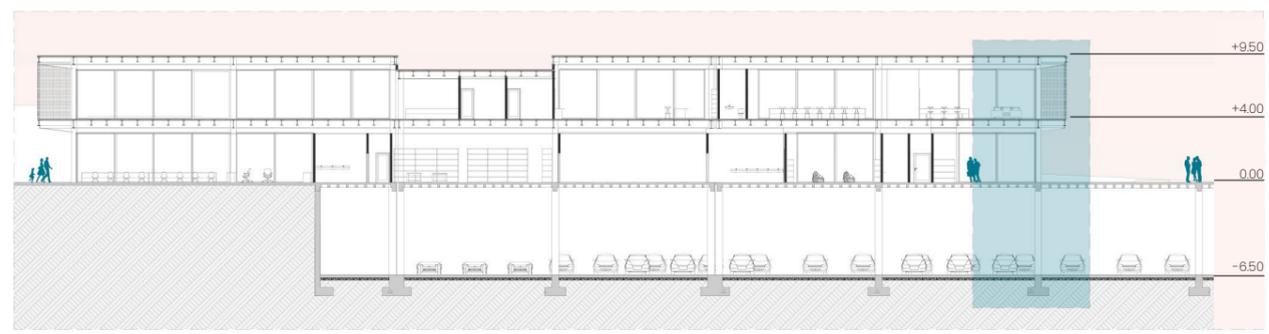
Sección constructiva bloque central Fuente: Propia, 2022
